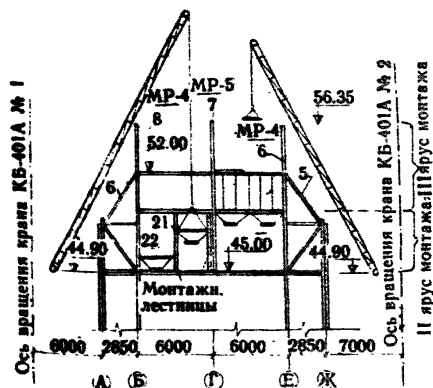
Схема монтажа металлических бункеров на отметке 52.00 в надстройке рабочего здания РЭС 4x175
